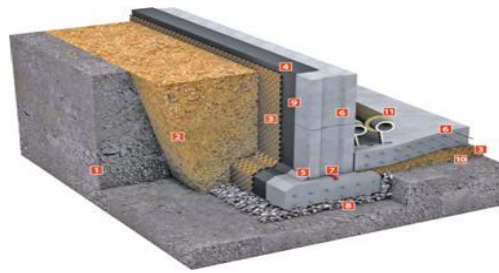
Система ТН-ФУНДАМЕНТ Стандарт: 1 – ґрунт; 2 – ґрунт зворотної засипки; 3 – профільована мембрана PLANTER standard; 4 – гідроізоляція ТЕХНОІКОЛЬ №21 (Техномаст); 5 – перехідний бортик (жолобник); 6 – залізобетонна конструкція фундаменту; 7 – набухаючий профіль; 8 – щебінь; 9 – праймер бітумний ТЕХНОІКОЛЬ №01; 10 – пісок; 11 – циліндр ТЕХНОІКОЛЬ
